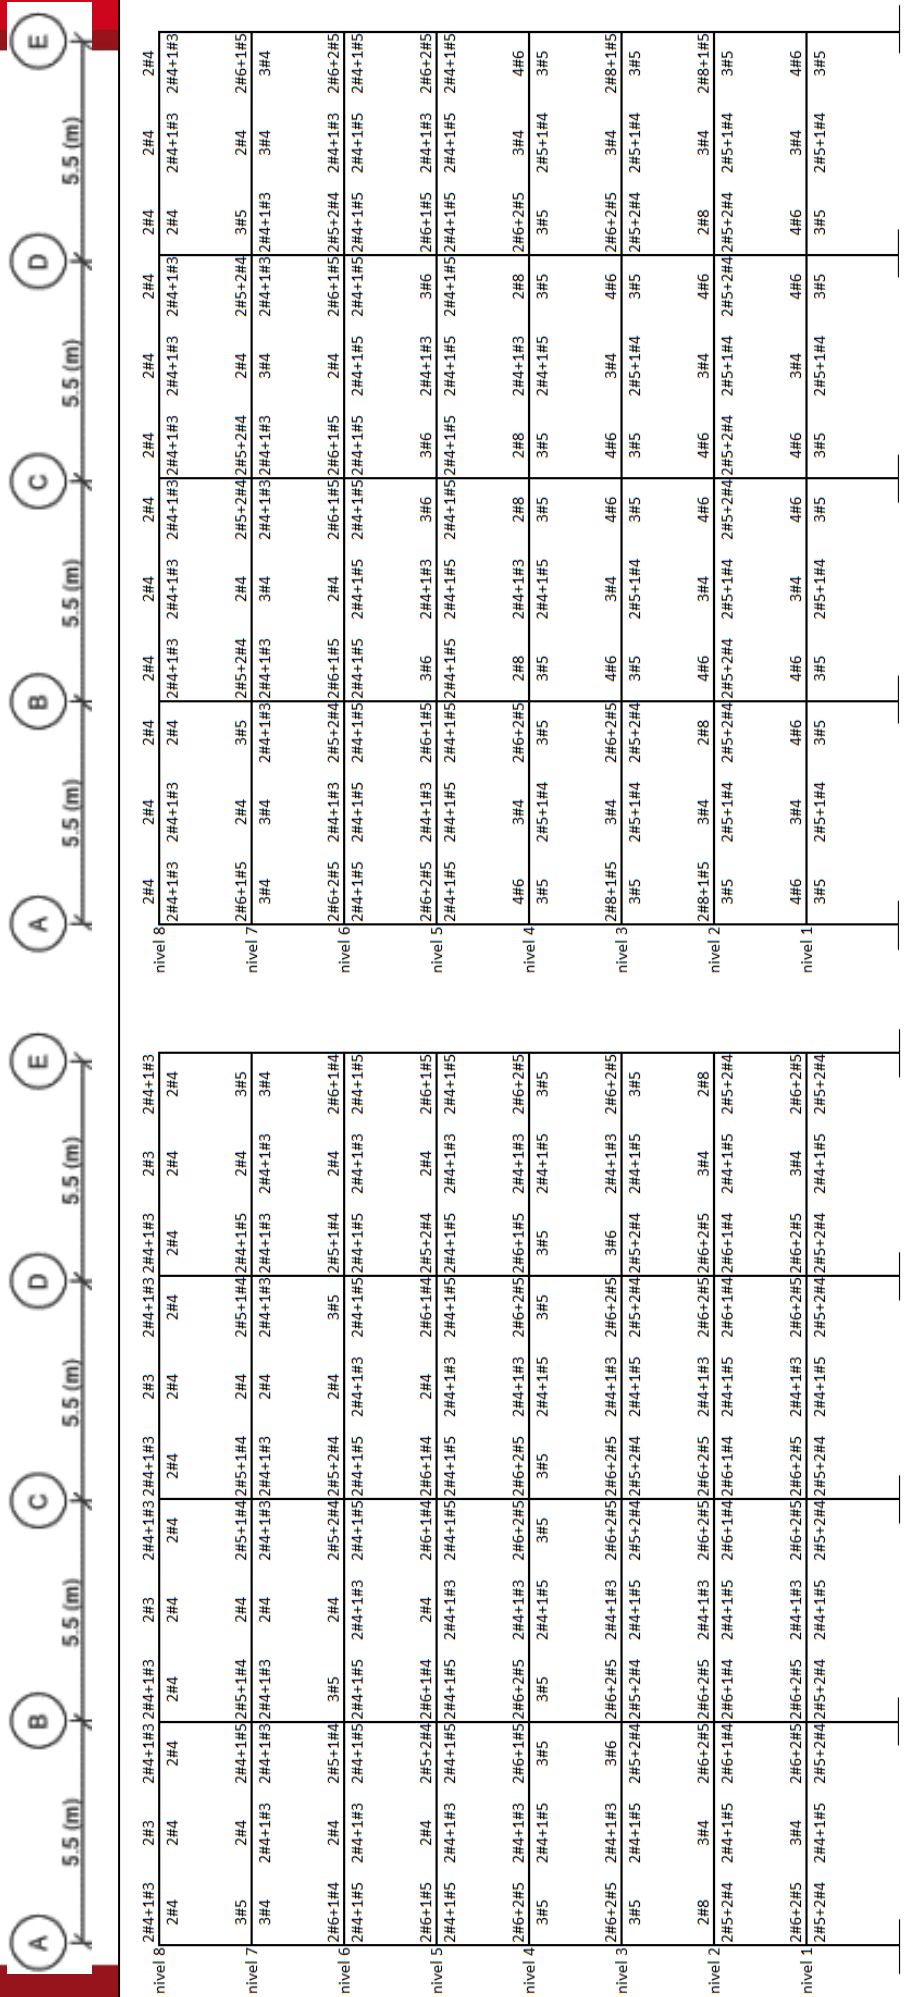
Barras de refuerzo grado 75 en las vigas del Pórtico eje 4
